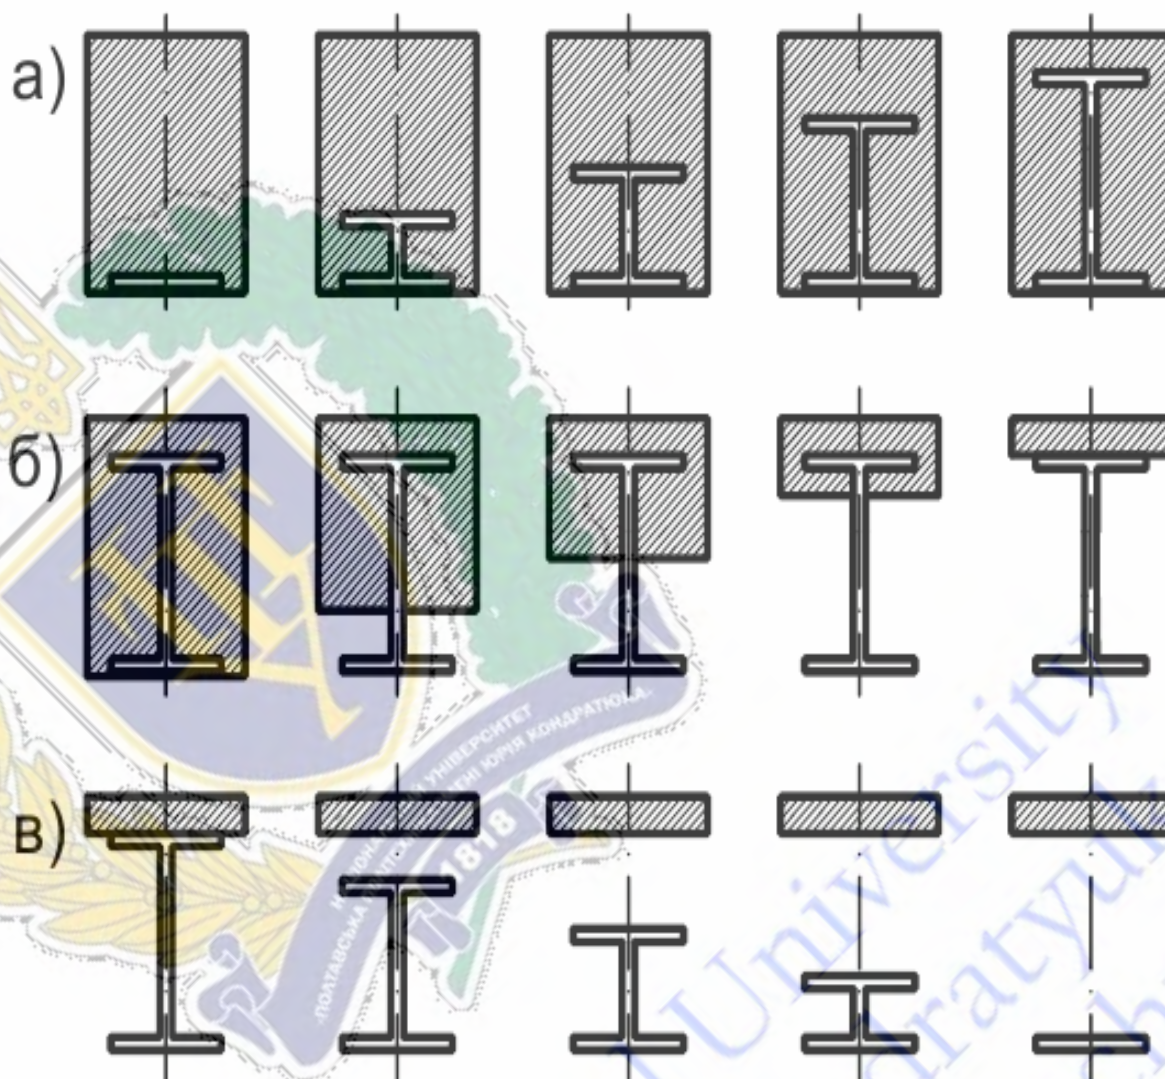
Характеристичні ряди приведених перерізів типових сталобетонних згинальних елементів: а) зміна армування прямокутного приведенного перерізу від залізобетонного (крайнього зліва) до сталобетонних елементів з жорстким армуванням; б) зміна приведенного прямокутного перерізу від сталобетонного з жорстким армуванням (крайнього зліва) до перерізів комбінованих сталобетонних елементів; в) зміна приведенного перерізу від комбінованого сталобетонного елемента (крайнього зліва) до перерізів комбінованих сталобетонних елементів з виносним зовнішнім армуванням
